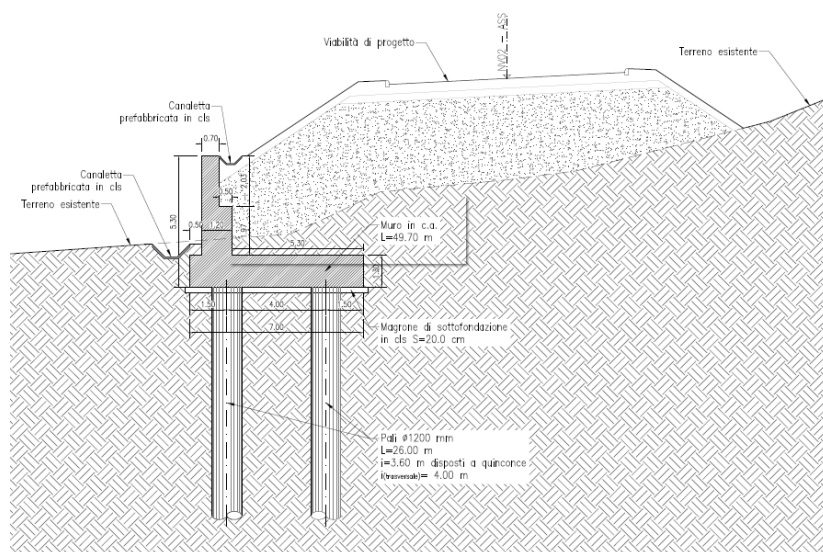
Sezione muro su pali in ca di contenimento rilevato stradale
